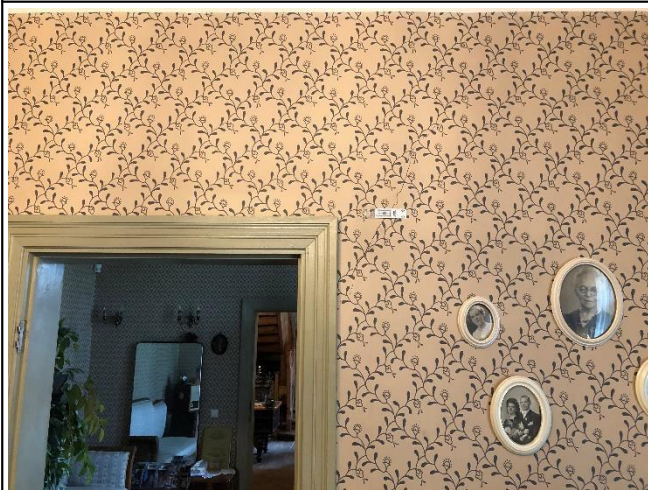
uz plaisas uzstādīts plaisu lineāls M1
